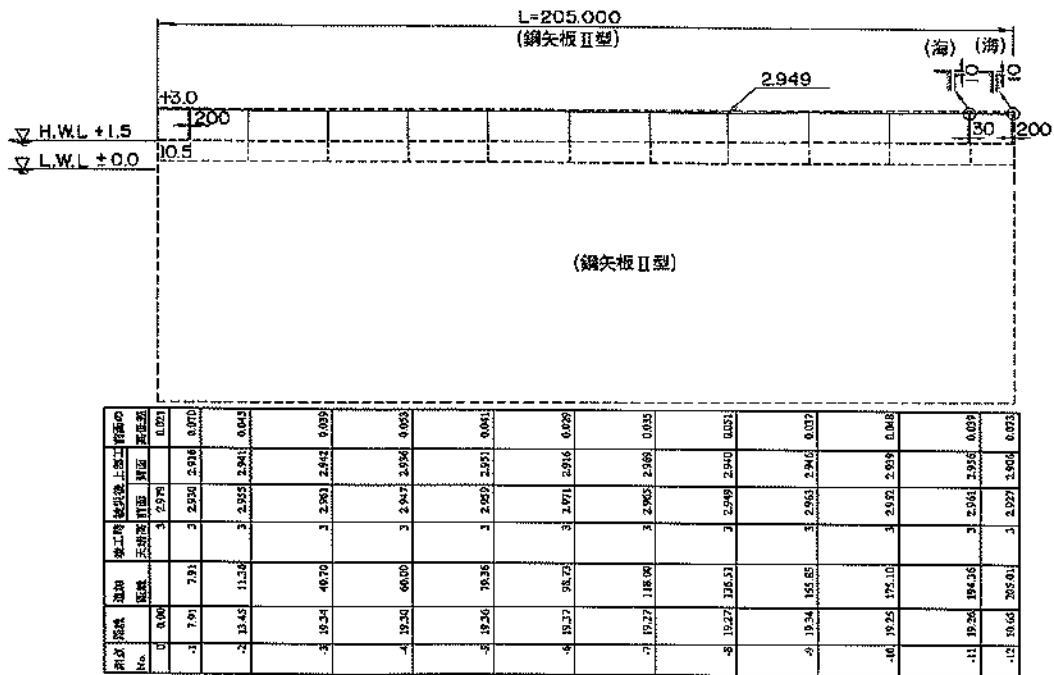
縦断面図 (第2埠頭地区, ㊸物揚場(-4.0m))
